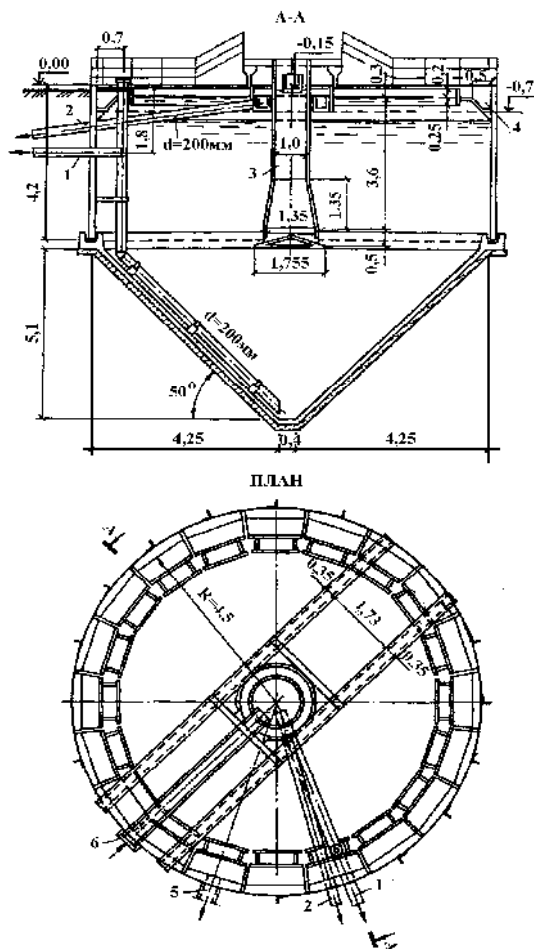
Первичный вертикальный отстойник из сборного железобетона:
